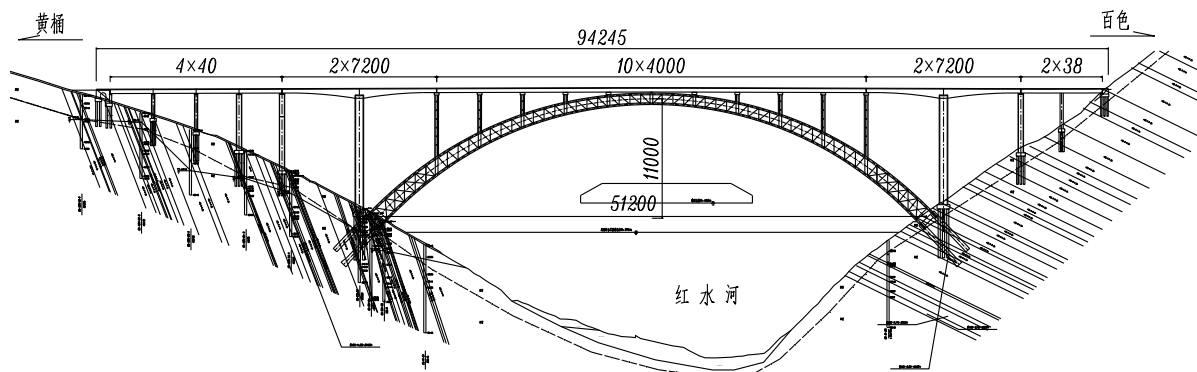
钢管拱方案孔跨布置示意图 (单位: cm)
